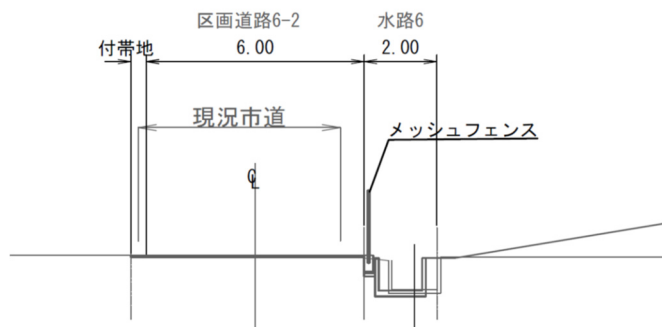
(8) 標準断面図(区画道路 6-2 幅員 6.0m)
